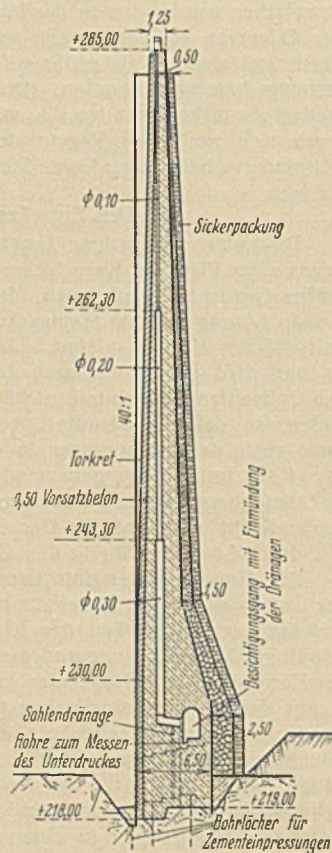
Betonkern mit Entwässerungssystem der Sorpetalsperre.
